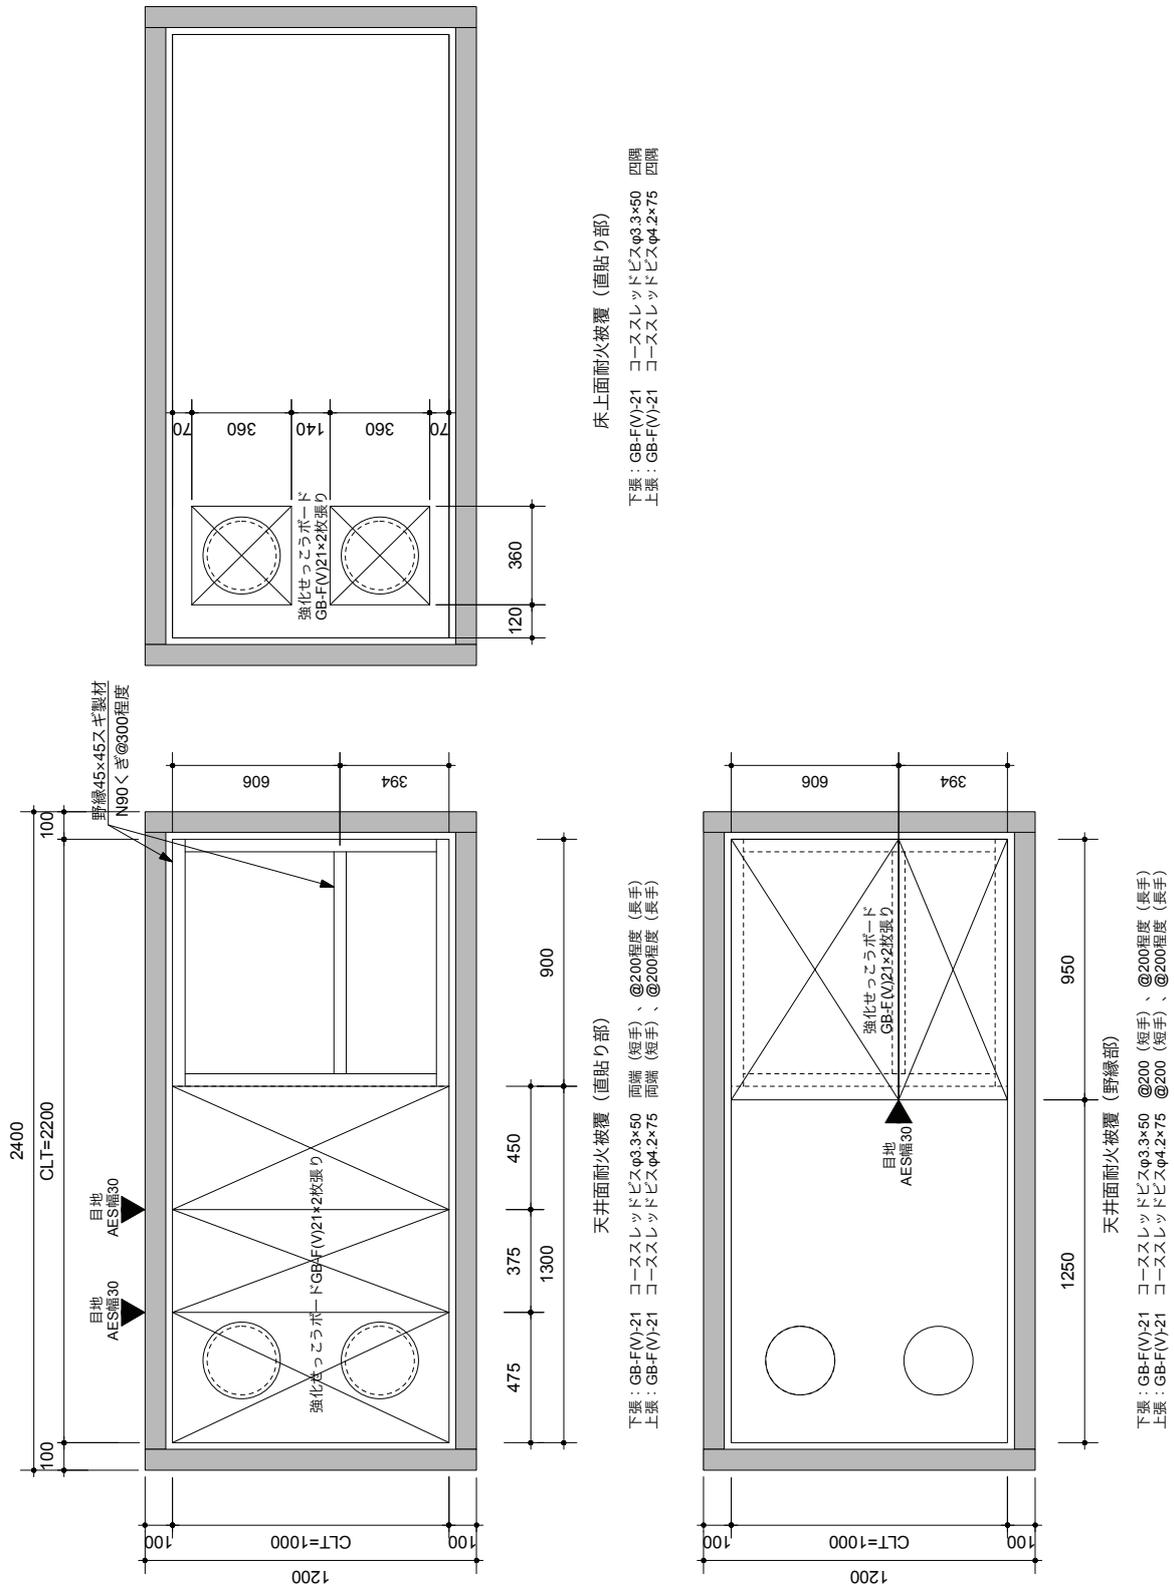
試験体 3 の構造・寸法・割付 (単位 : mm)
